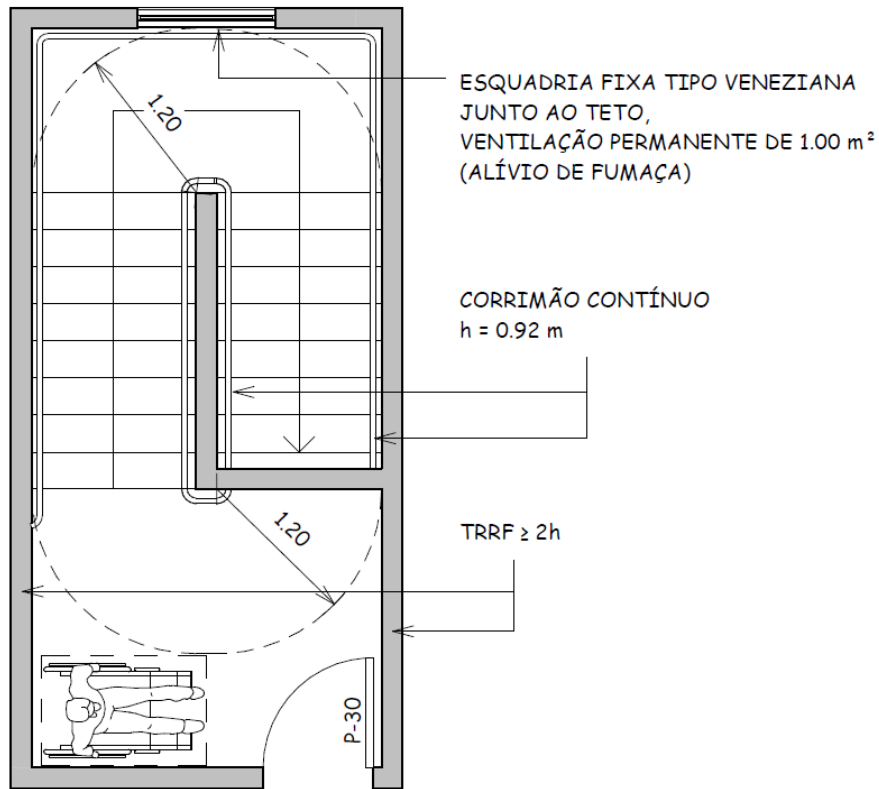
C - Escada protegida - último pavimento (planta baixa).
